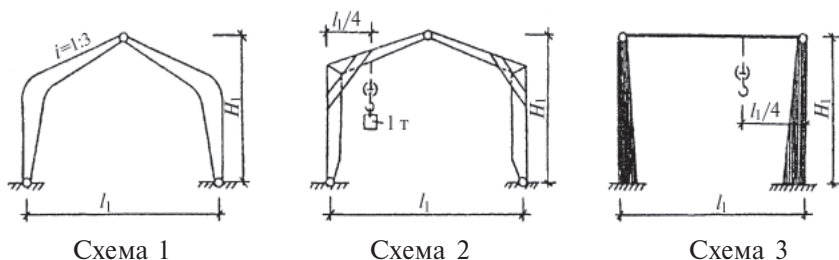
Схемы поперечных рам одноэтажного каркасного здания
